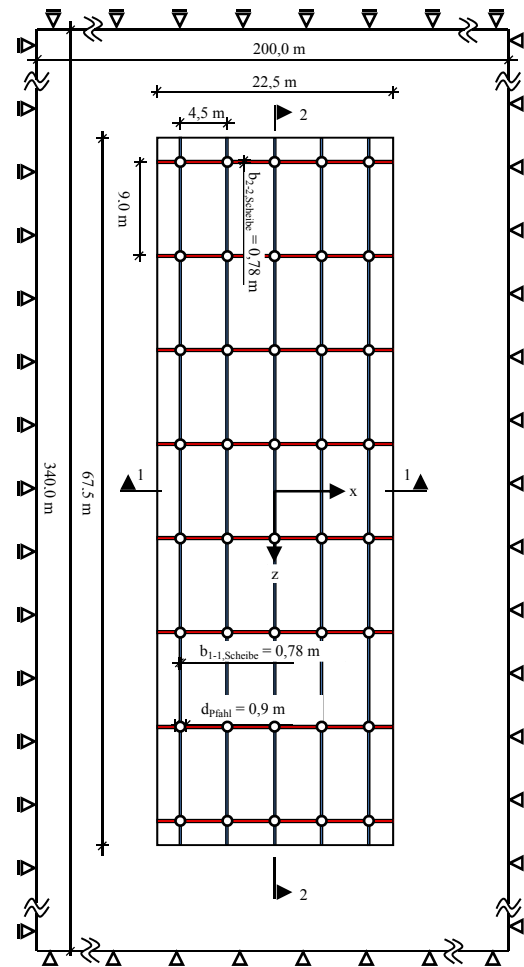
Grundriss Pfahlgründung mit Vereinfachungsschema für ebene Betrachtung
